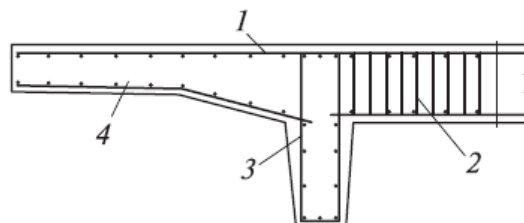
Схема армирования плитно-ребристого поперечного сечения ненапрягаемой арматурой:
